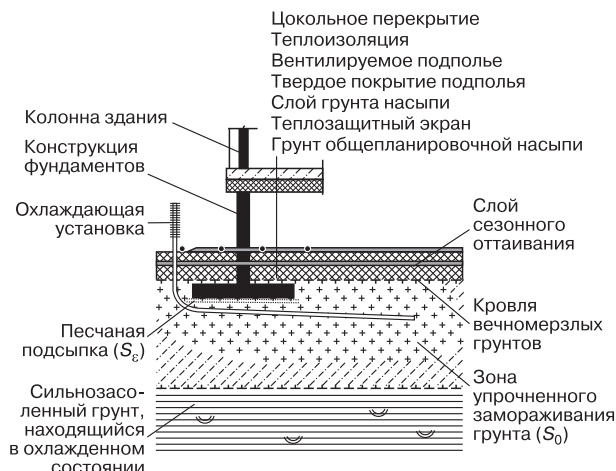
Схема фундамента, опирающегося на кровлю вечномерзлых грунтов, по I принципу строительства и эксплуатации.
